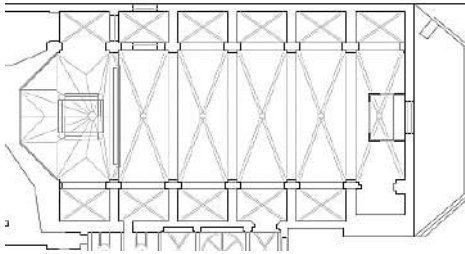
Detalle de la planta de la iglesia en sección. Imagen propia 20/08/17
